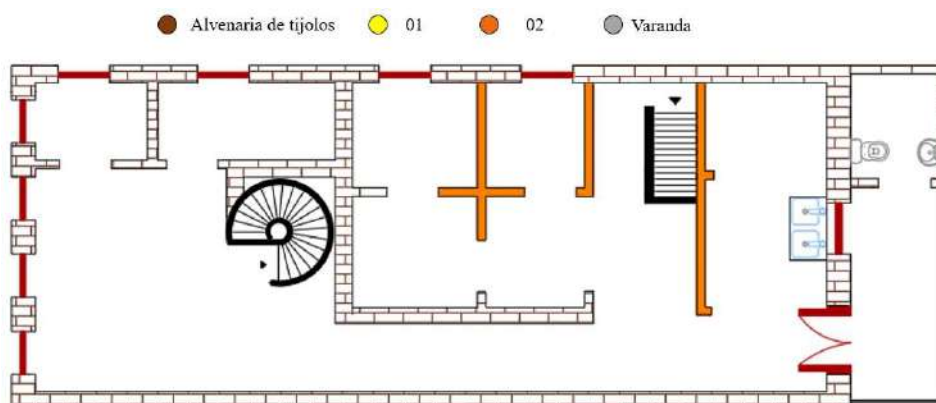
Planta-baixa, piso inferior, casa nº 246, Rua Barão de São Borja, Boa Vista
